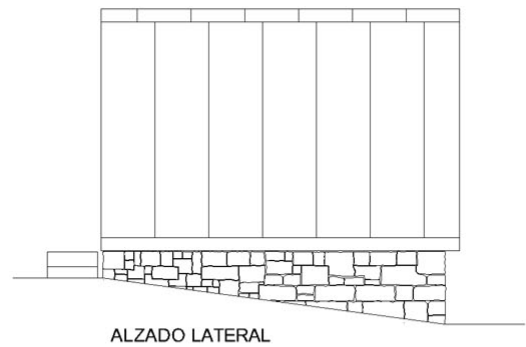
1 Cementerio de Fisterra. Panteón tipo. Alzado.
